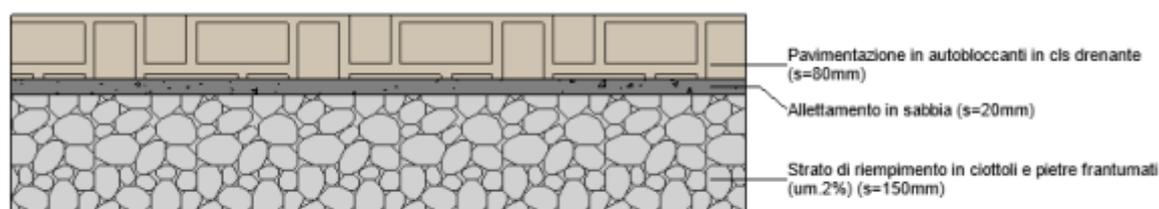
Stratigrafia pavimentazione esterna – stato di progetto
